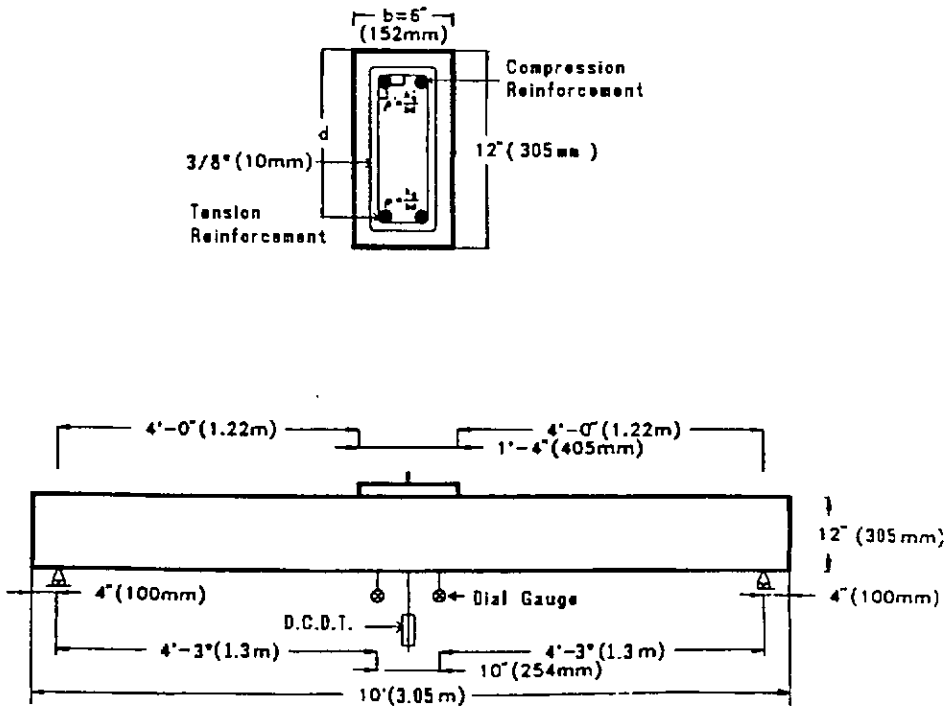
Seção transversal e dimensões das vigas ensaiadas por Shin, Kamara e Ghosh [41].
